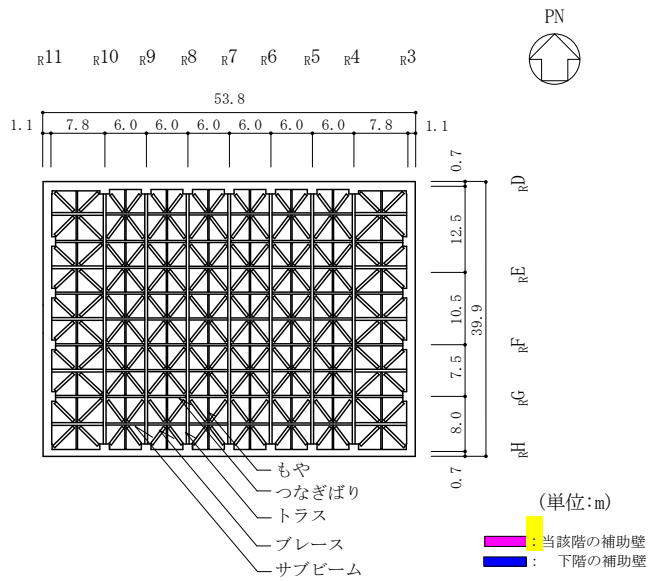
(8) 補助壁の配置図 (EL 63.5m)
